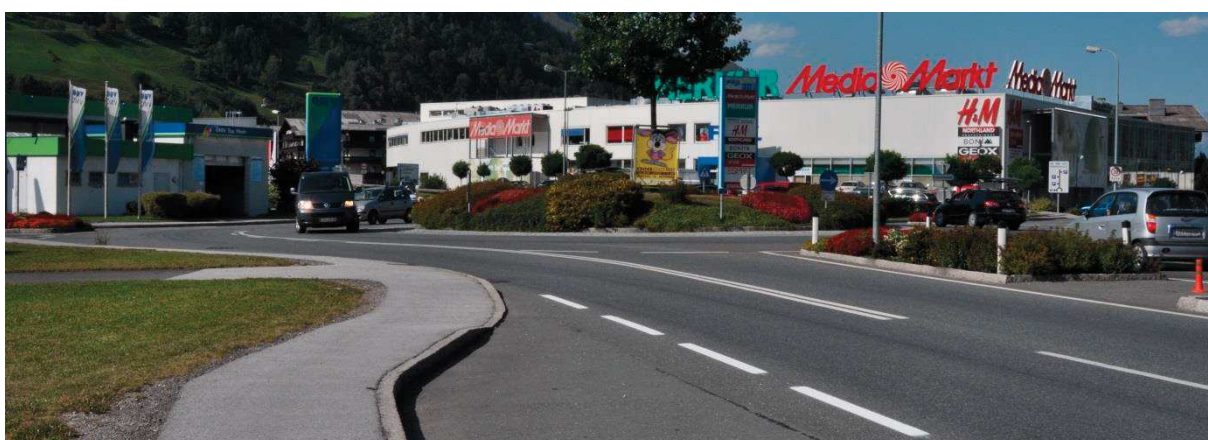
České Budějovice – detail fyzického oddělení jízdnic pruhů na okružním pásu.
